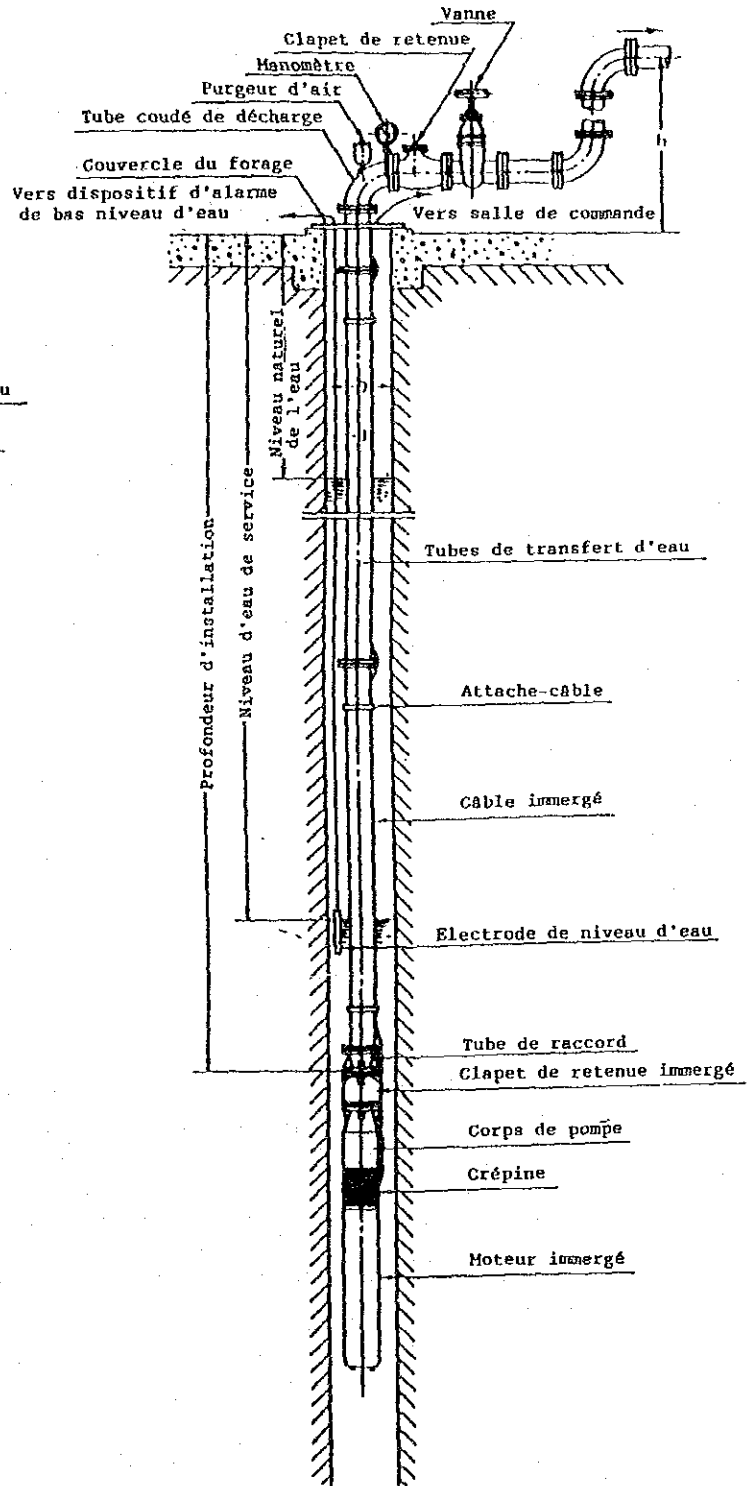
Plan standard d'une installation de captage de l'eau par forage
